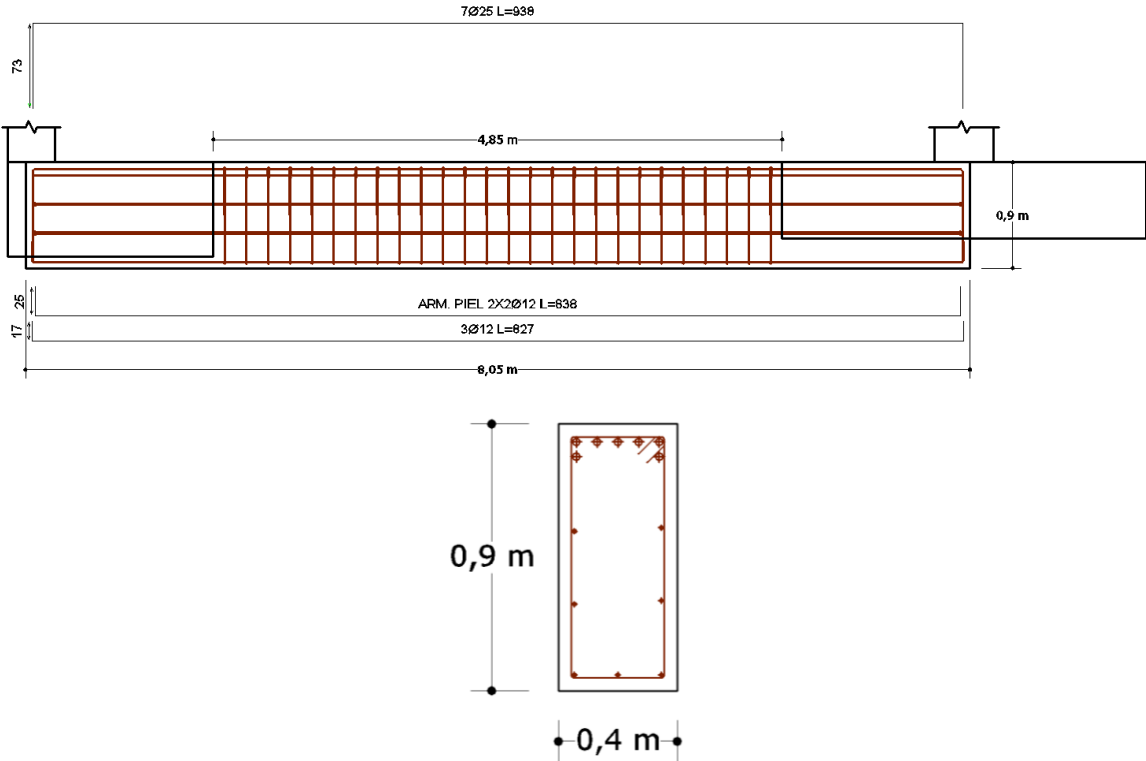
Despiece Zapata con Viga Centradora: ; Elaboración Propia
